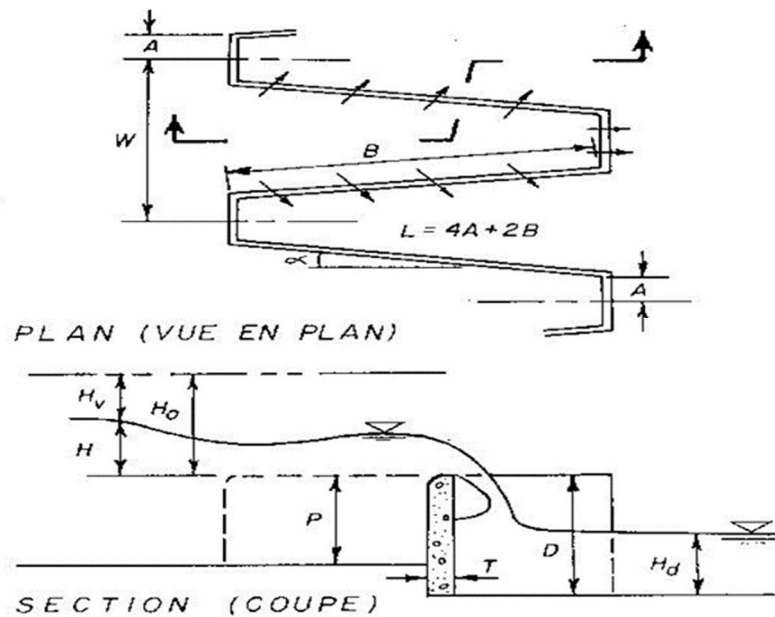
vue en plan et coupe longitudinale d'un seuil labyrinthe
